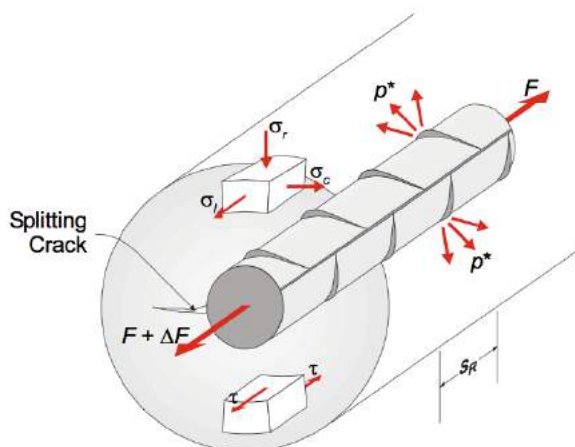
Fisuras transversales longitudinales por splitting. (FIB, 2000).
